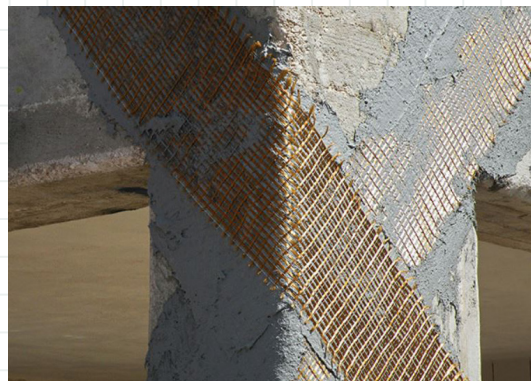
applicazione del sistema FRCM sui nodi pilastro-trave
